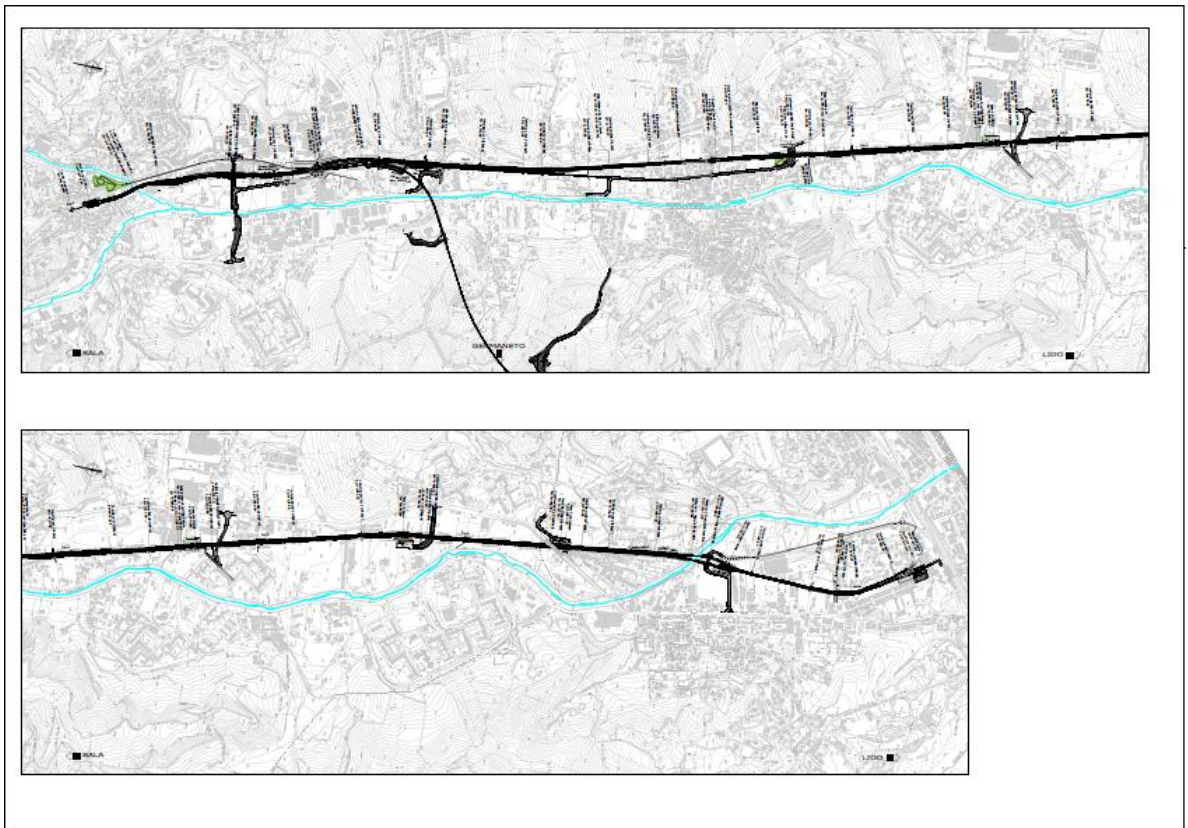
Planimetria generale di progetto - Linee A e B, (VIANINI LAVORI S.p.A. ; ARES S.p.A.; CO.GE.FOR S.R.L., 2016).
